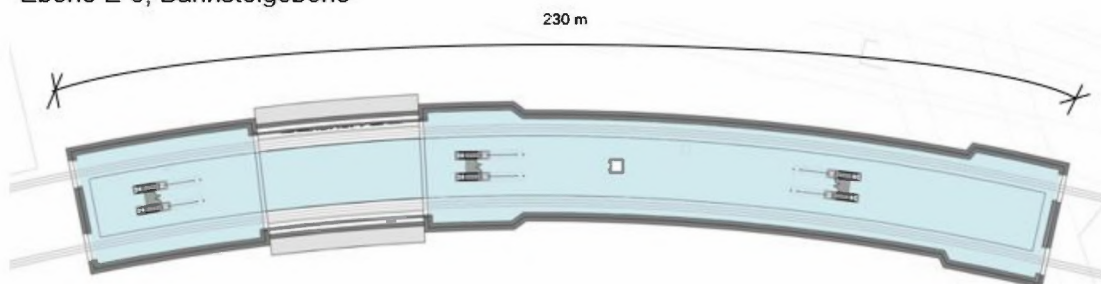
Hp Dammtor Var. III – Grundrisse
